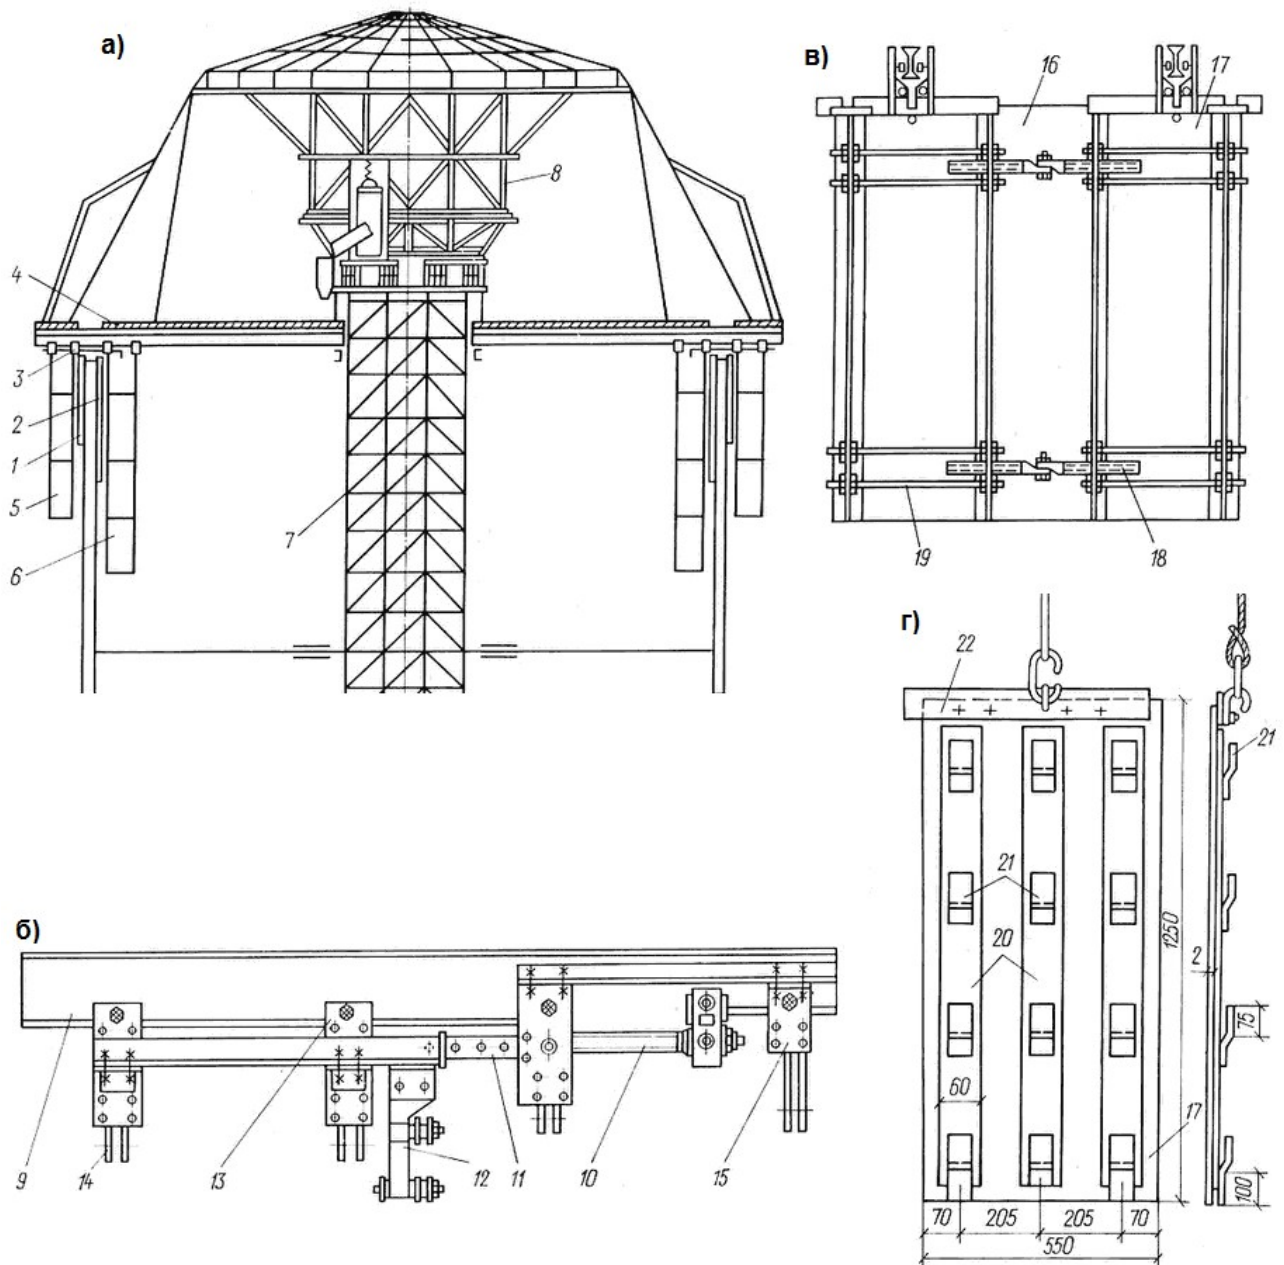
Устрій підйомно-переставної опалубки: а – загальний вид опалубки; б – механізм радіального переміщення щитів опалубки; в – стяжка щитом зовнішньої опалубки; г – щит внутрішньої опалубки; 1 – щити зовнішньої опалубки; 2 – внутрішня опалубка; 3 – механізм радіального переміщення; 4 – робочий майданчик; 5 – підвісні риштування зовнішні; 6 – підвісні риштування внутрішні; 7 – шахтний підйомник; 8 – підйомна головка; 9 – головна радіальна балка; 10 – гвинт радіального переміщення; 11 – трубка-фіксатор; 12 – роликів підвіска панелі радіального переміщення; 13 – ролик підвіски; 14 – підвіска зовнішніх лісів; 15 – підвіска внутрішніх лісів; 16 – кінцева панель; 17 – прямокутний щит; 18 – стяжні болти; 19 – стяжки; 20 – сталеві смуги; 21 – скоби зі смугової сталі; 22 – смугова накладка
